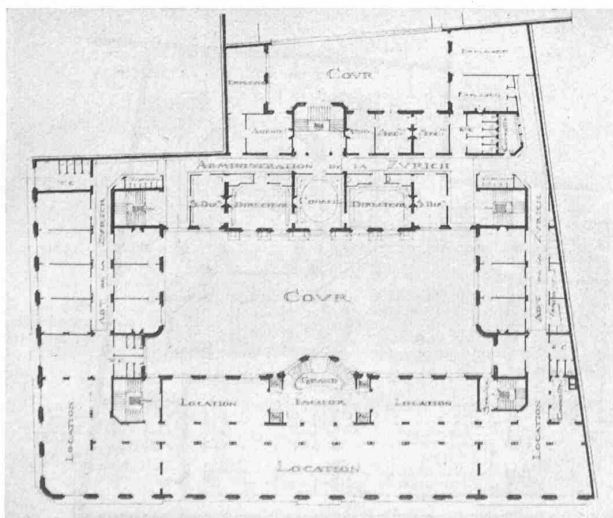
Obergeschoss-Grundriss. 1:800. — Entwurf Arch. Patouillard, Paris. — Abb. 12. Schnitt durch Vorder- und Hintergebäude. — 1:600.
